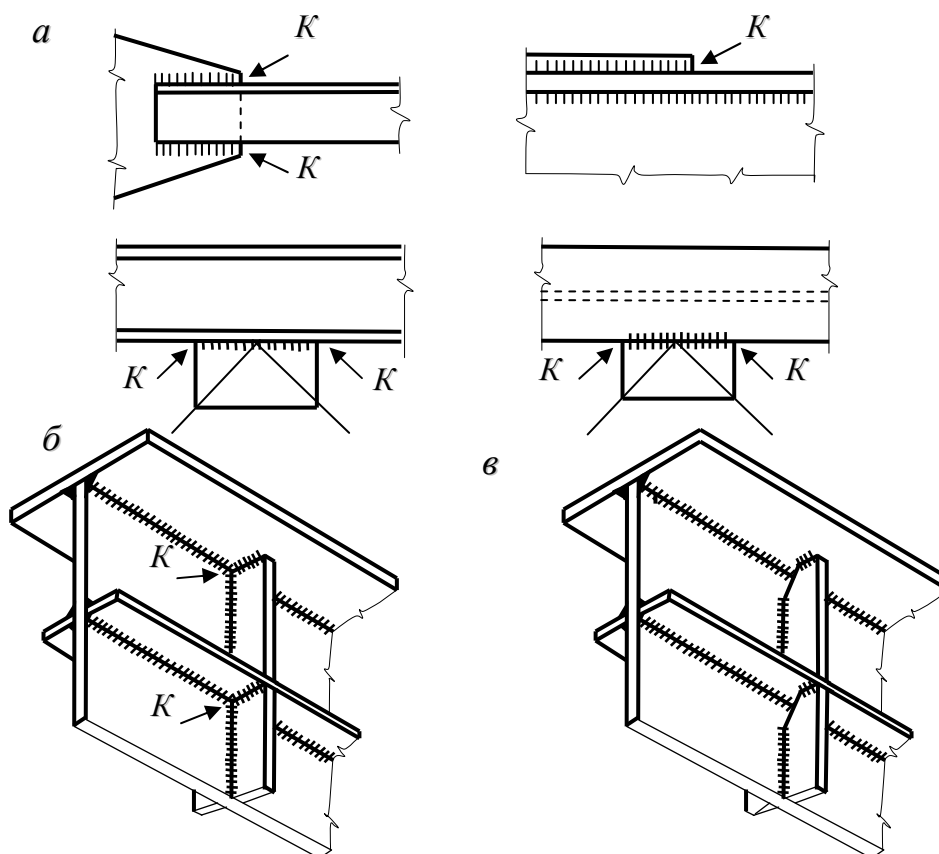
Стыки сварных конструкций с концентраторами местных напряжений: а, б – с концентраторами; в – рекомендуемый
